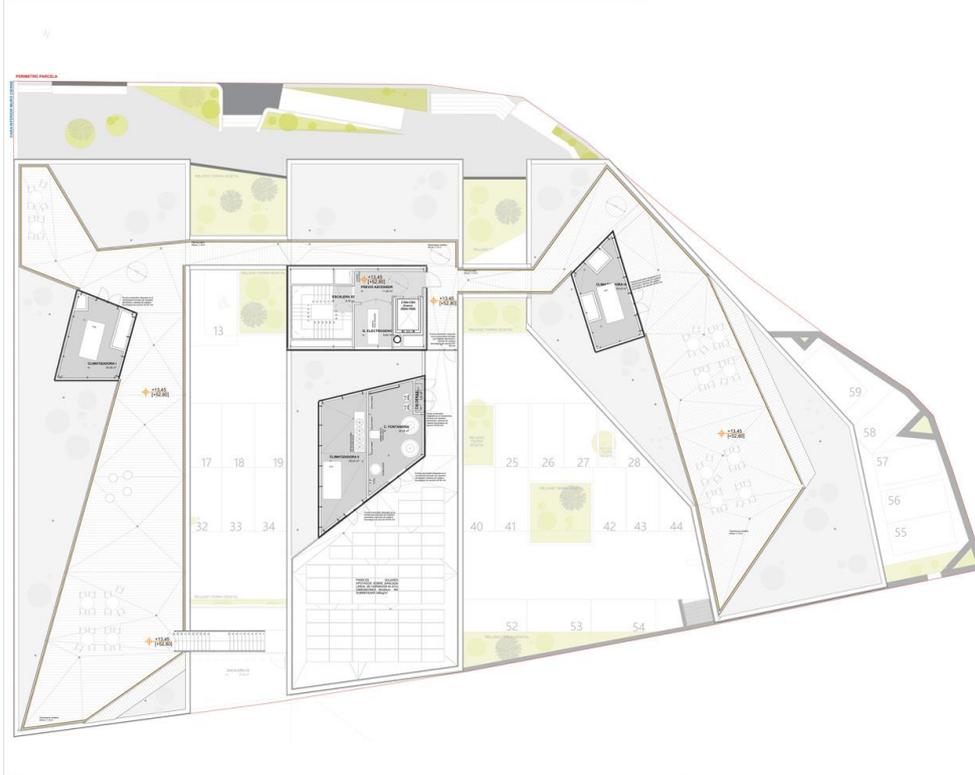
Planta baixa primeiro pavimento (Andar tipo).
